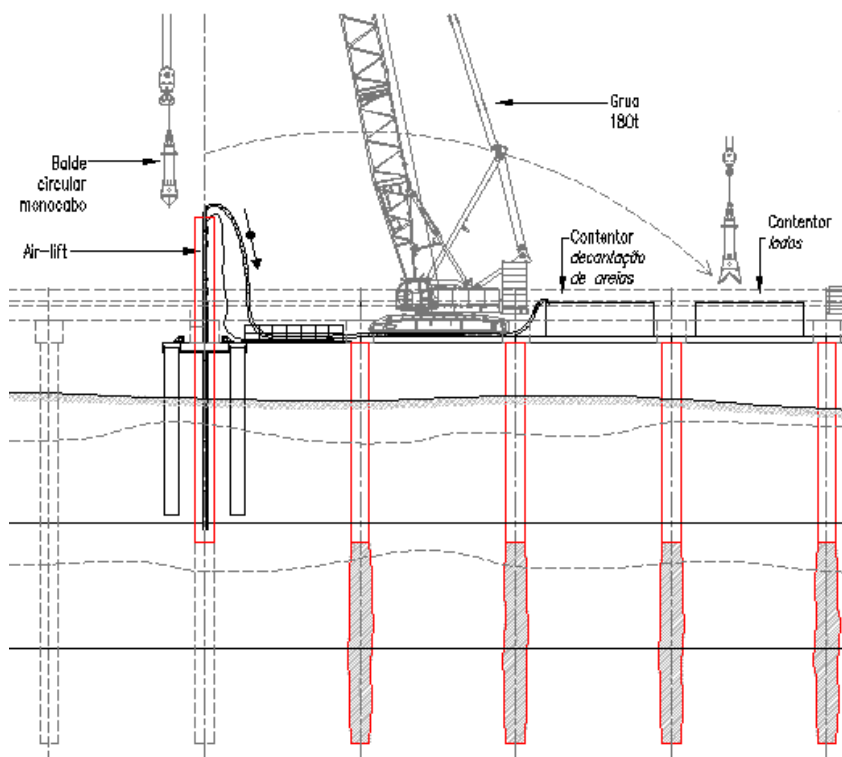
Fase 2 – Limpeza/escavação do interior do encamisamento.
